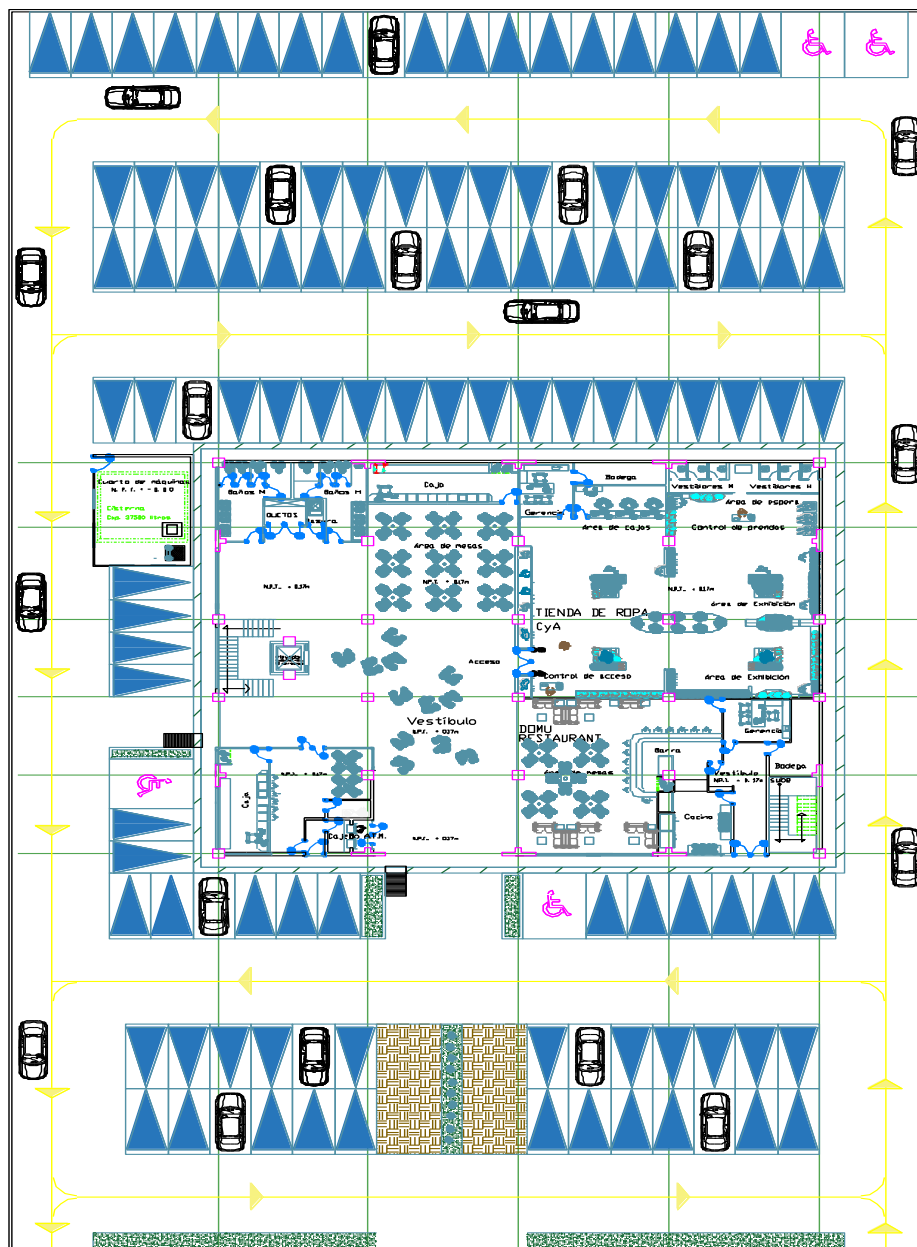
Vista en planta del proyecto. (Fuente Propia).
